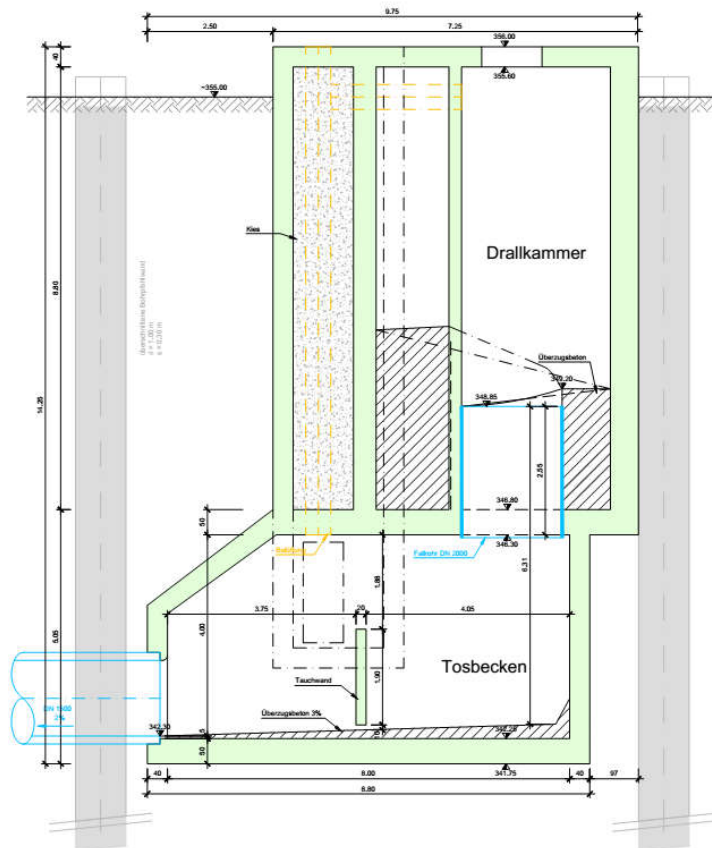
Auszug Plan 105 Wirbelfallschacht/Tosbecken
